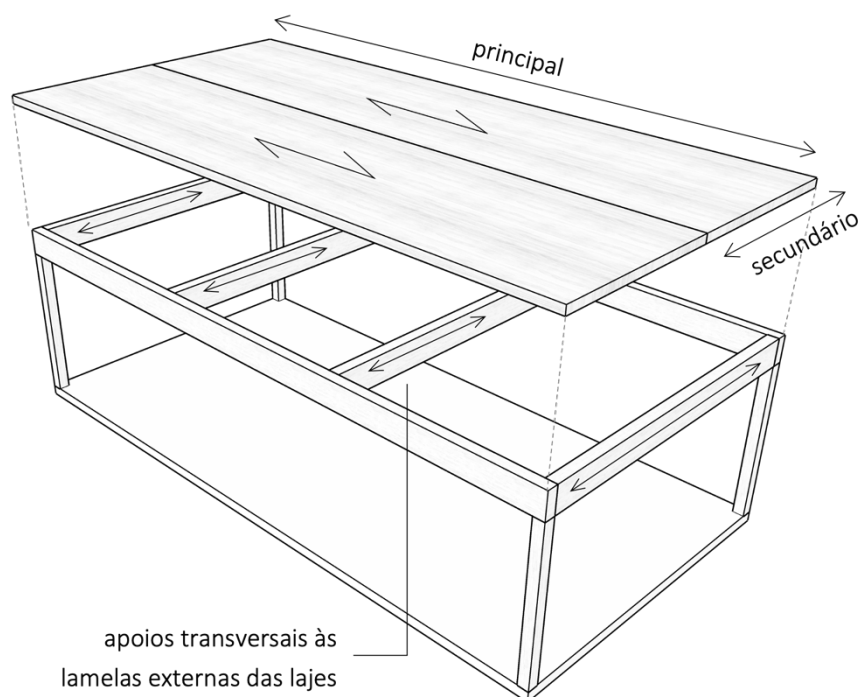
Esquema de configuração estrutural fictícia representando o comportamento estrutural de lajes de MLCC.
